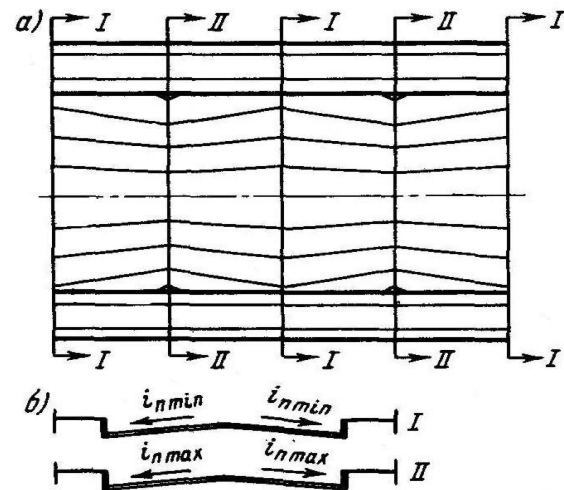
Вертикальне планування з пилкоподібним профілем лотка [53]: а) план вулиці; б) поперечні профілі
